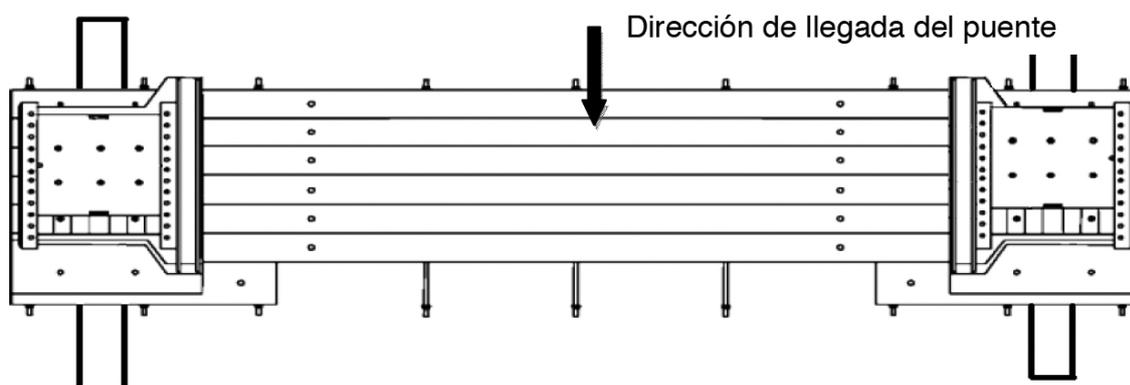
Vista en planta Montaje de las vigas de apoyo, enrejado, plancha soporte y apoyos
